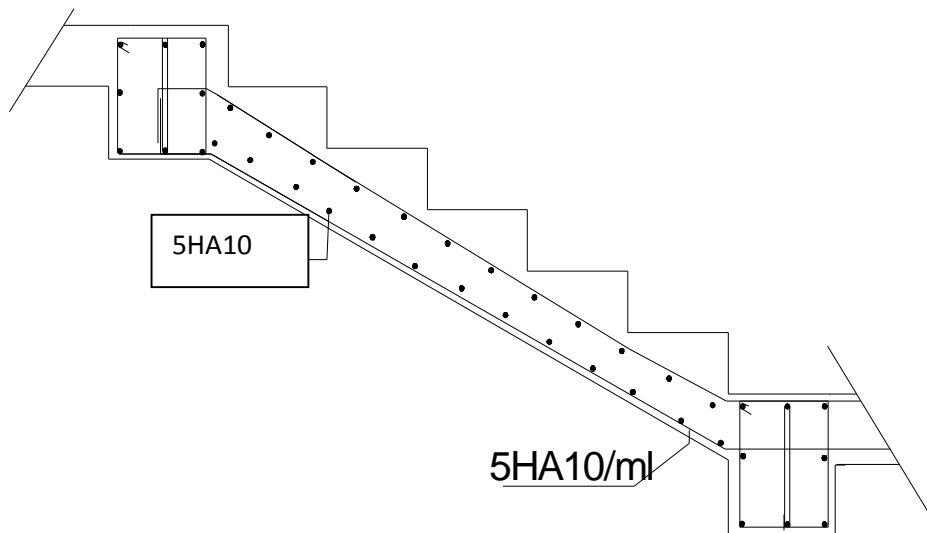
Schéma de ferrailage de l'escalier de RDC
